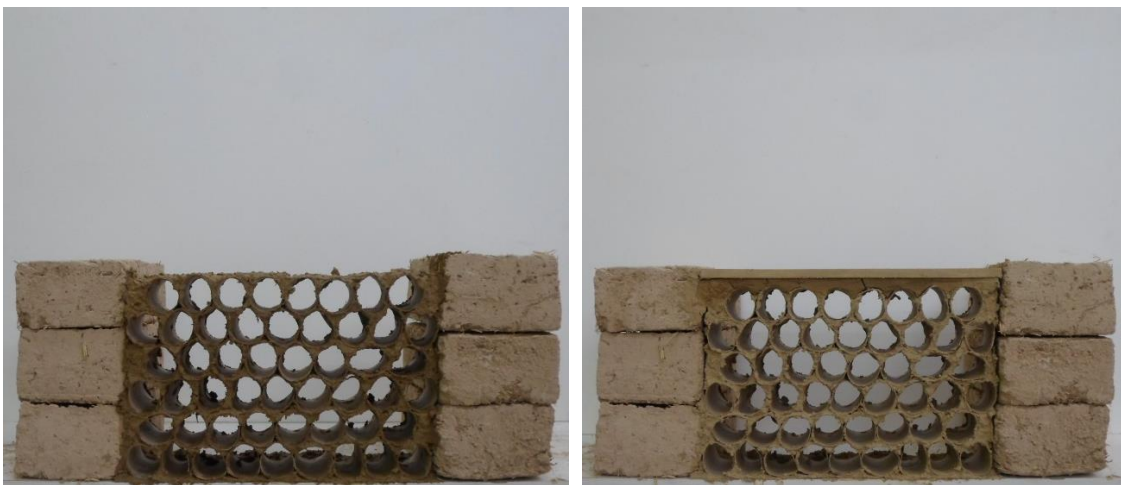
y 77. Muro de WCM. Fuente. Elaboración propia.
